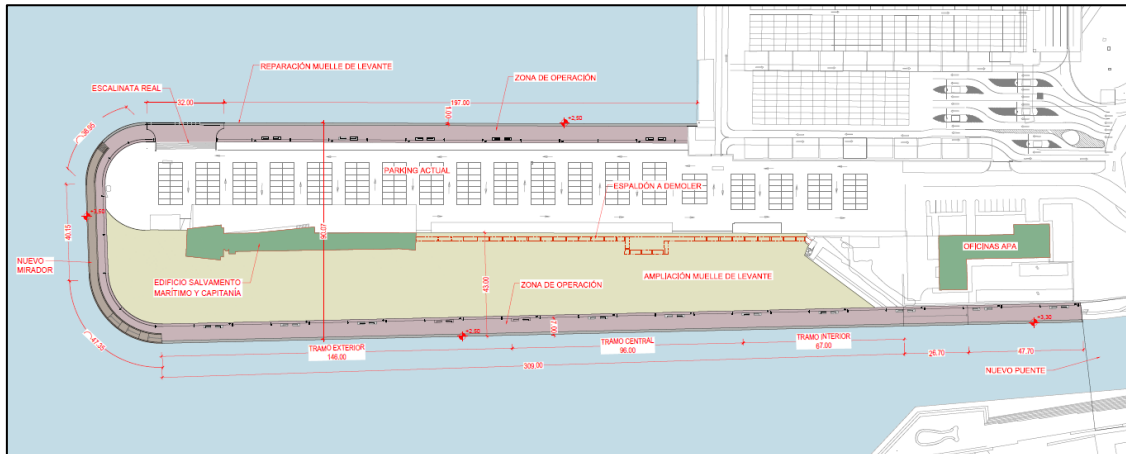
Planta de la actuación propuesta en el Muelle de Levante
